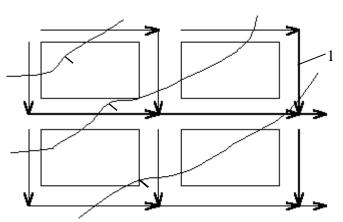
Объемлющая схема трассировки сети водоотвода 1 — направление водоотвода
